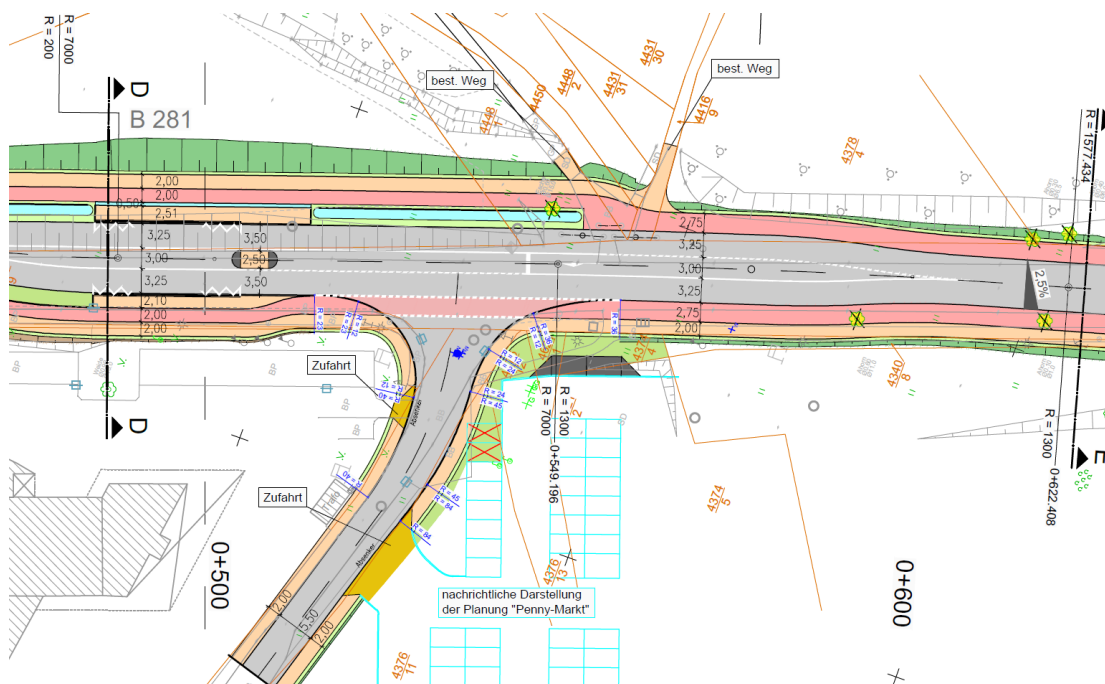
Ausbaubereich Am Eichelteich: Bushalt mit Querungshilfe (Auszug aus dem technischen Lageplan - Vorplanung 2017)
